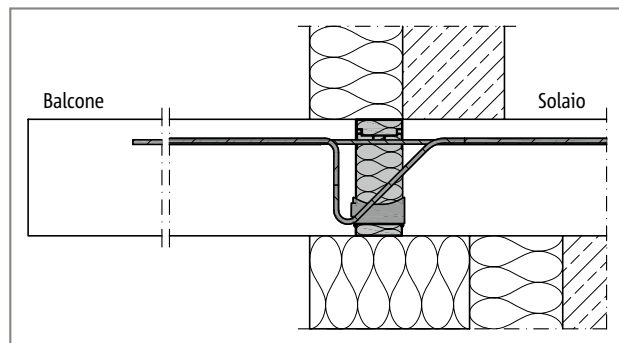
Schöck Isokorb® T tipo KL: raccordo indiretto al solaio con cappotto
